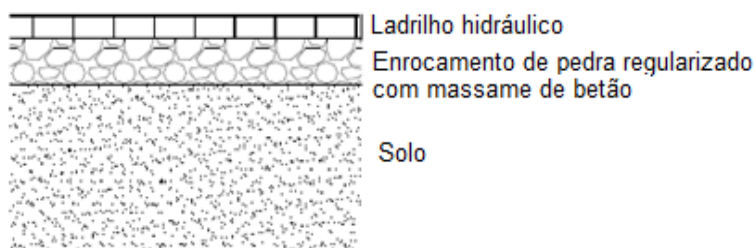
Previsível constituição do pavimento térreo da fração A
